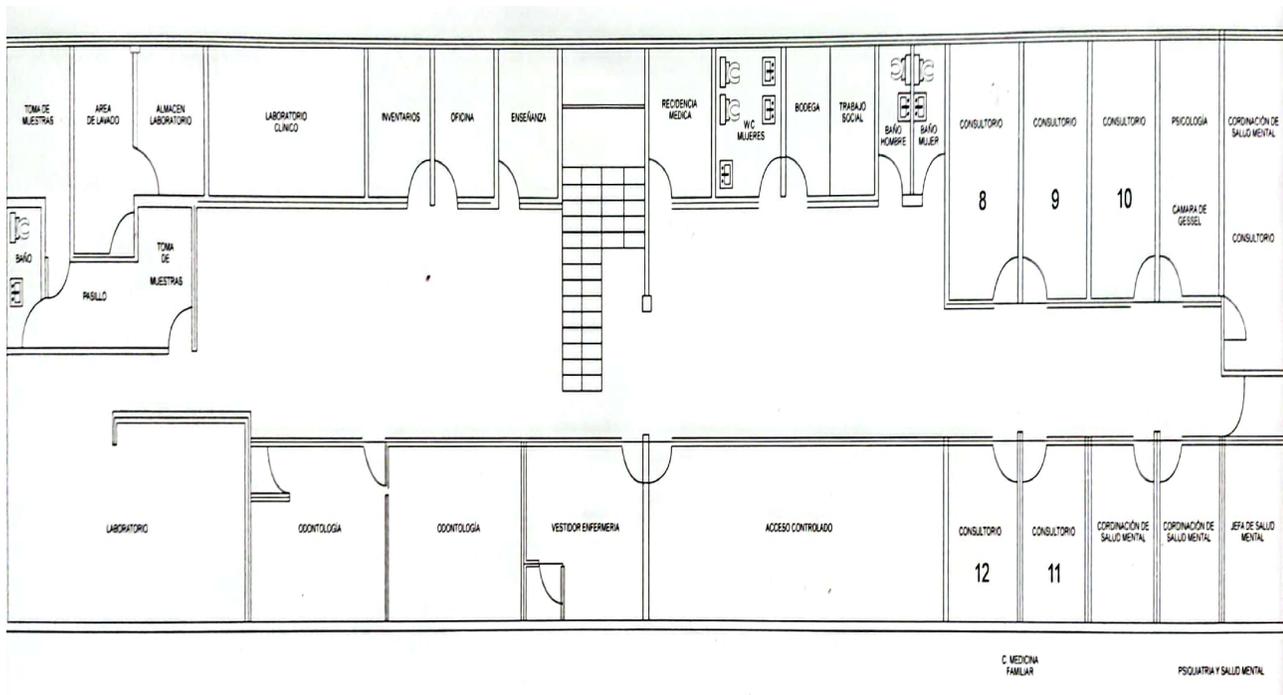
Plano de la Unidad “CST-III Dr José Castro Villagrana”: Planta Alta
